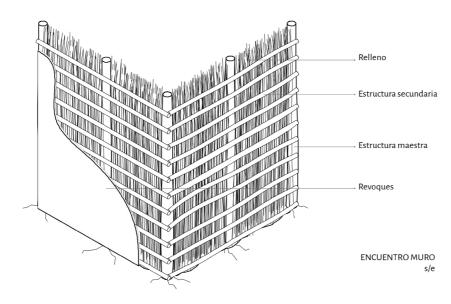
Encuentro de muro con TMT. Fuente: Elaboración propia.
